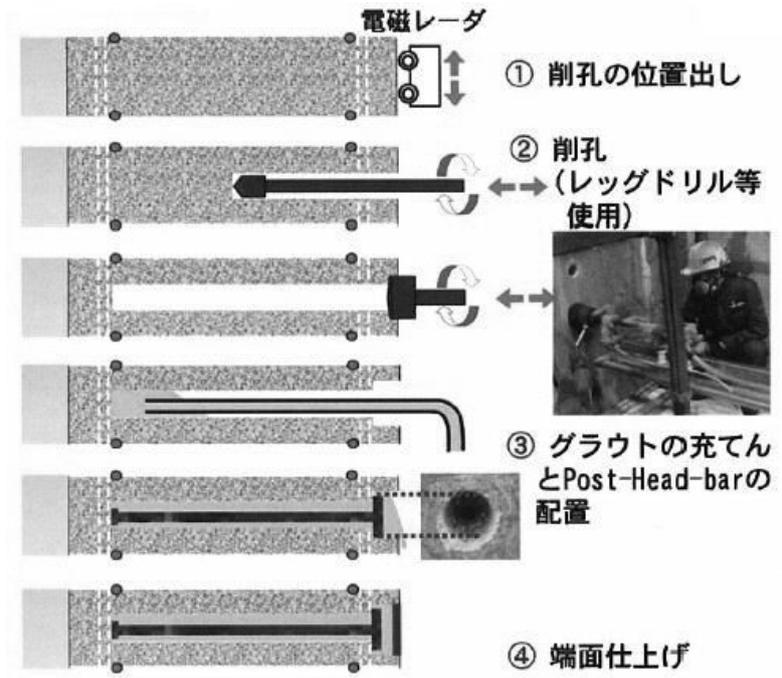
後施工鉄筋補強筋工法による補強概要図
